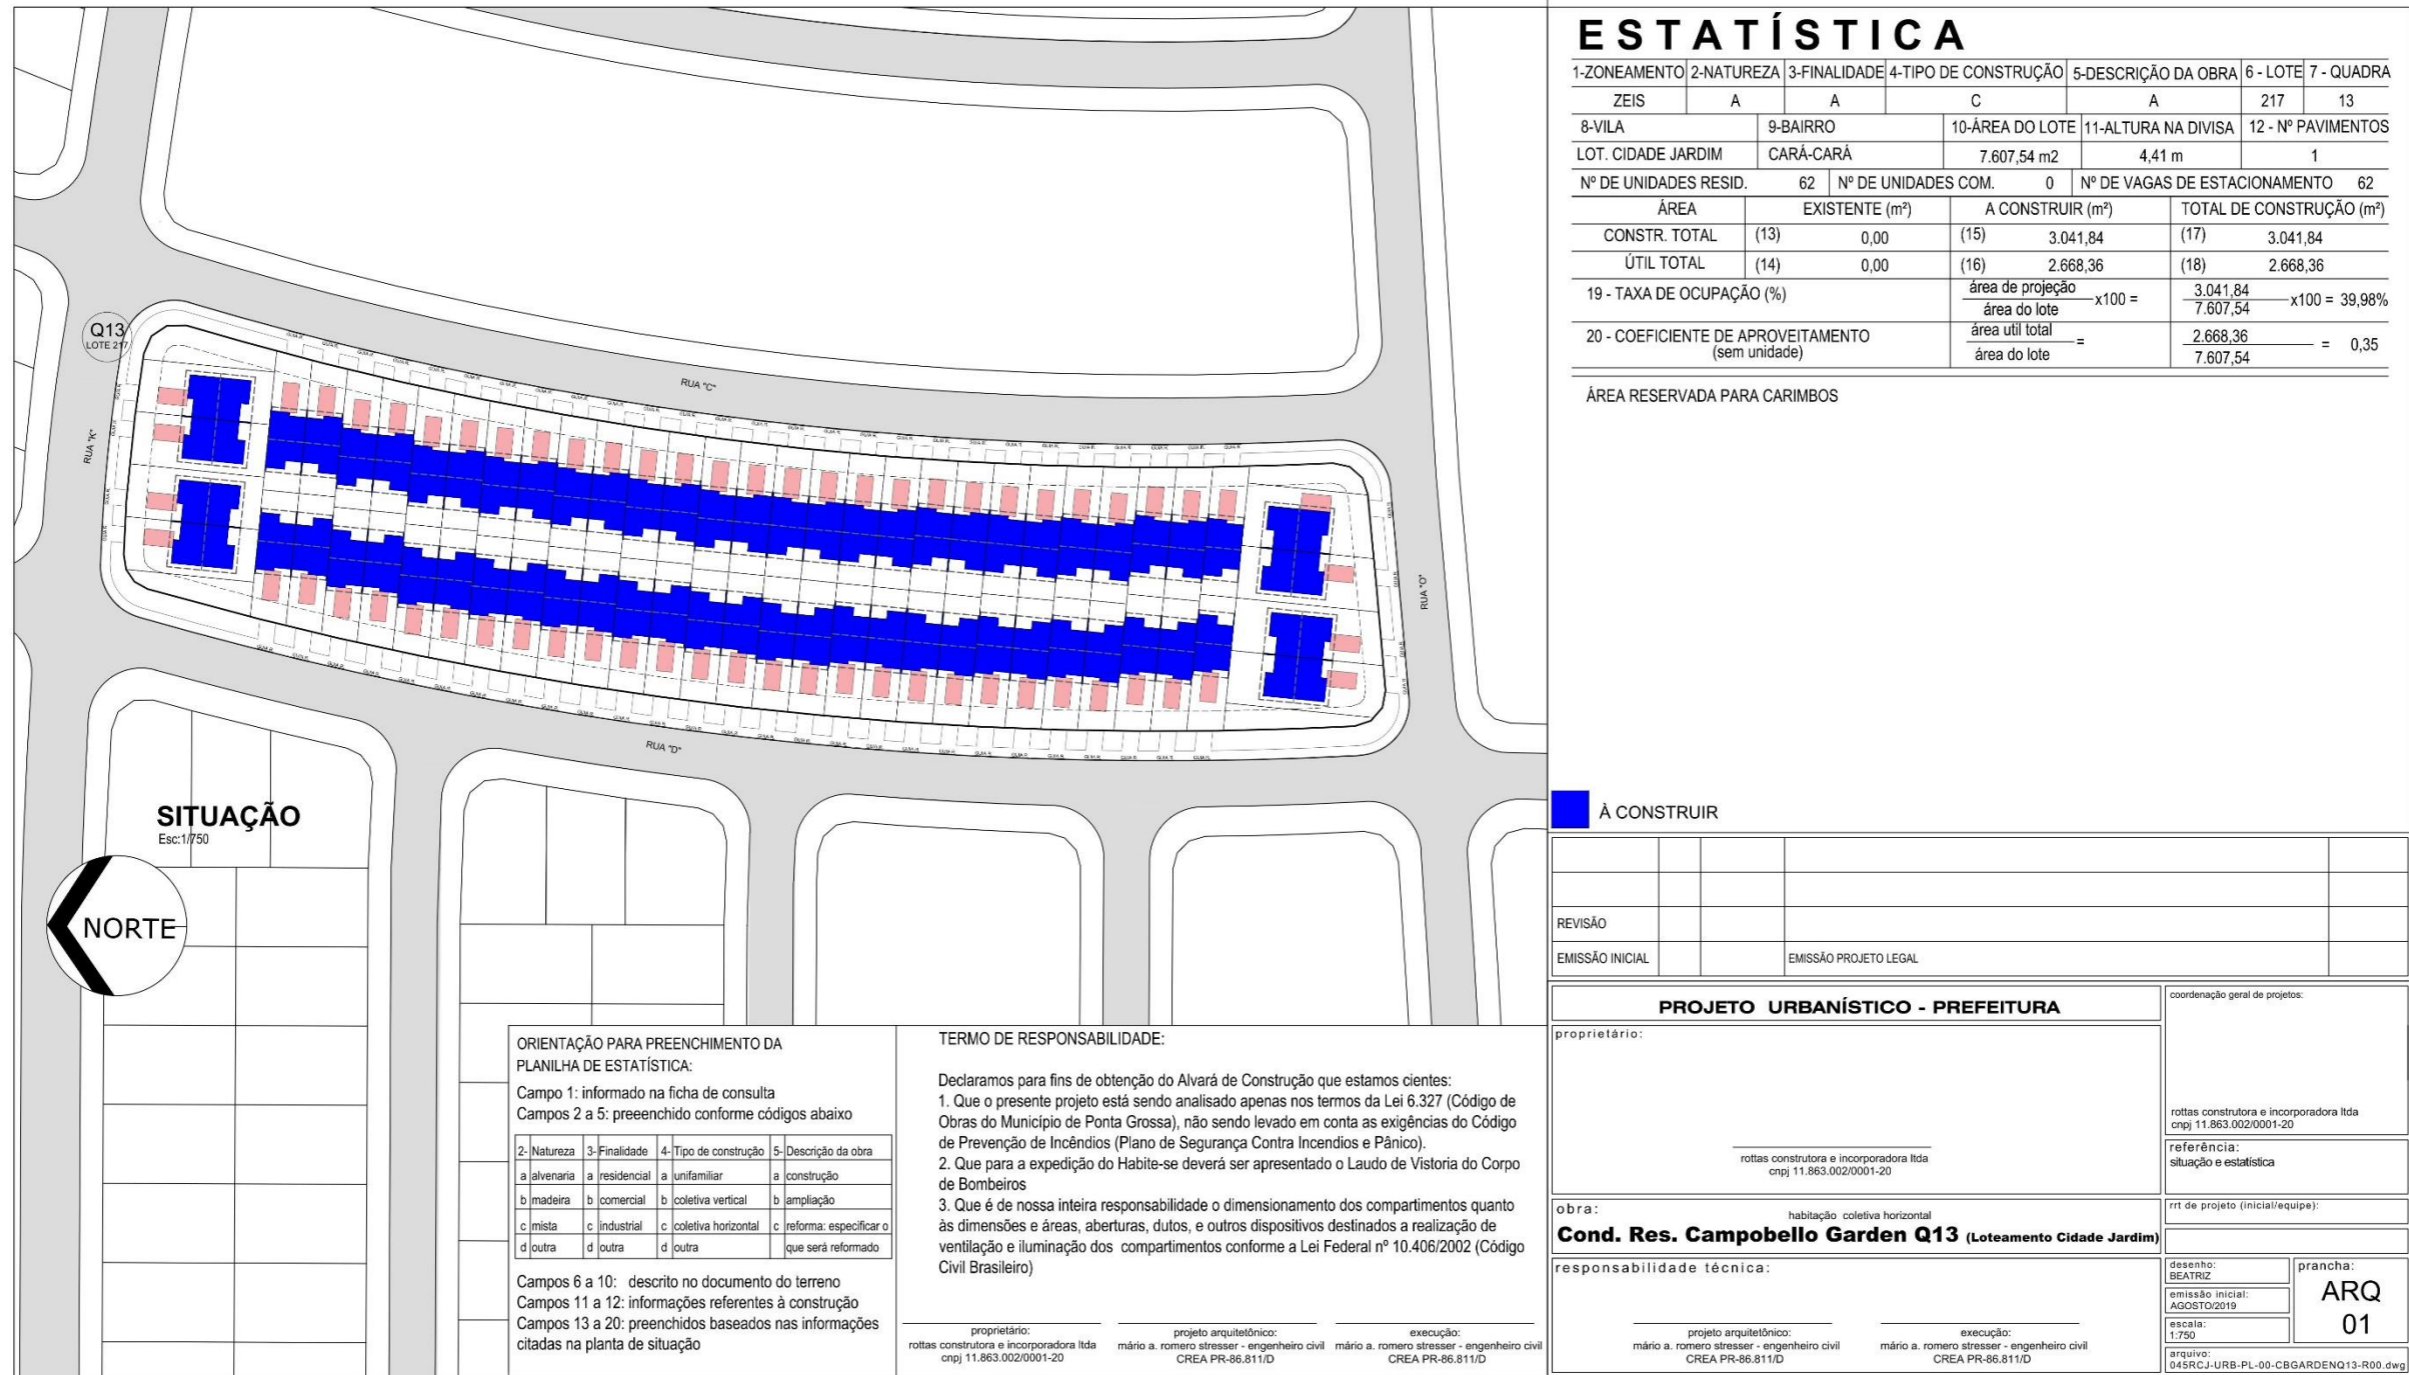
Projeto Urbanístico – Planta de Situação da Quadra 13 (Prancha 01).
